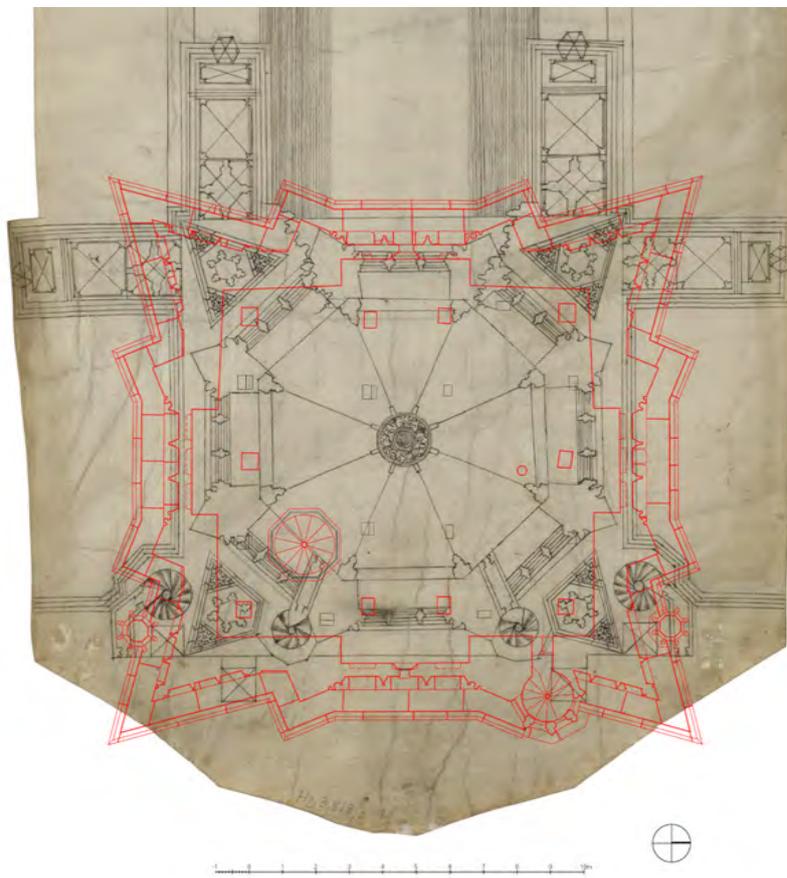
Überlagerung mit dem Grundriss des Sternengeschosses, bei mittiger Positionierung
